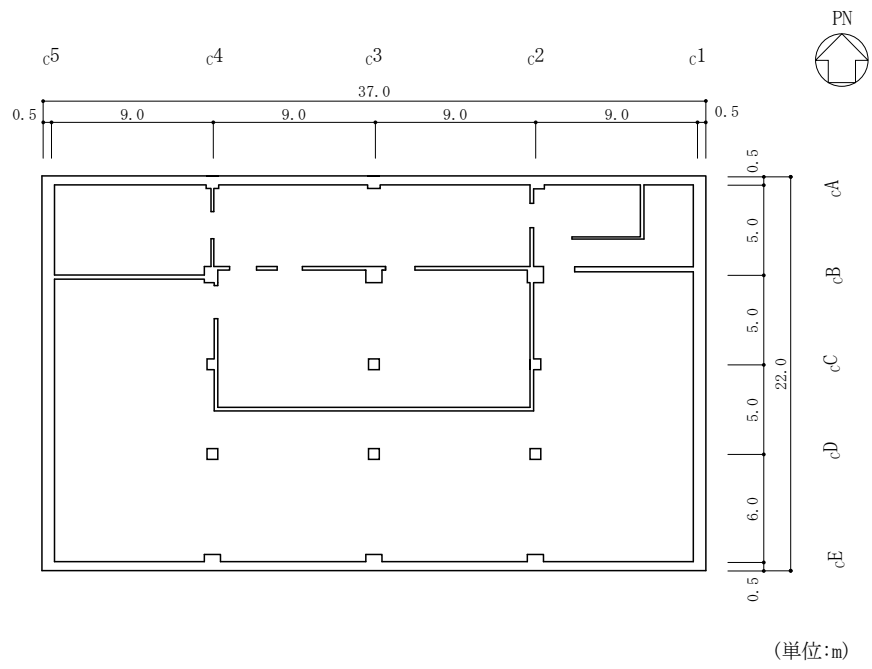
(3) 制御室建物の概略平面図 (EL 12.8m)
